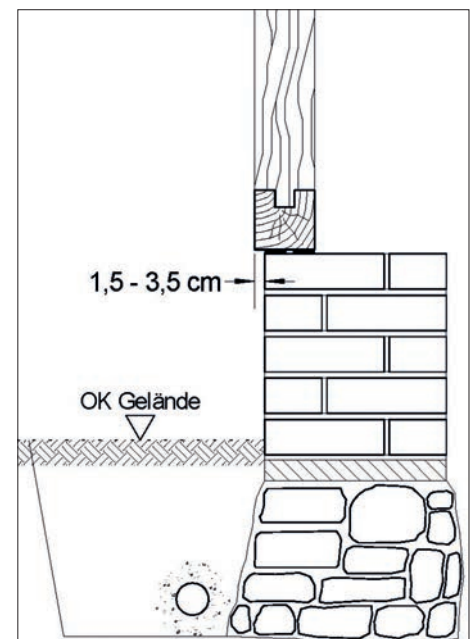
Die Grundschwelle sollte gegenüber dem Sockel um 1,5 – 3,5 cm vorstehen, damit Wasser ungehindert ablaufen kann. Ist dies nicht möglich, sollte ein vorstehender Sockel abgeschrägt werden.
